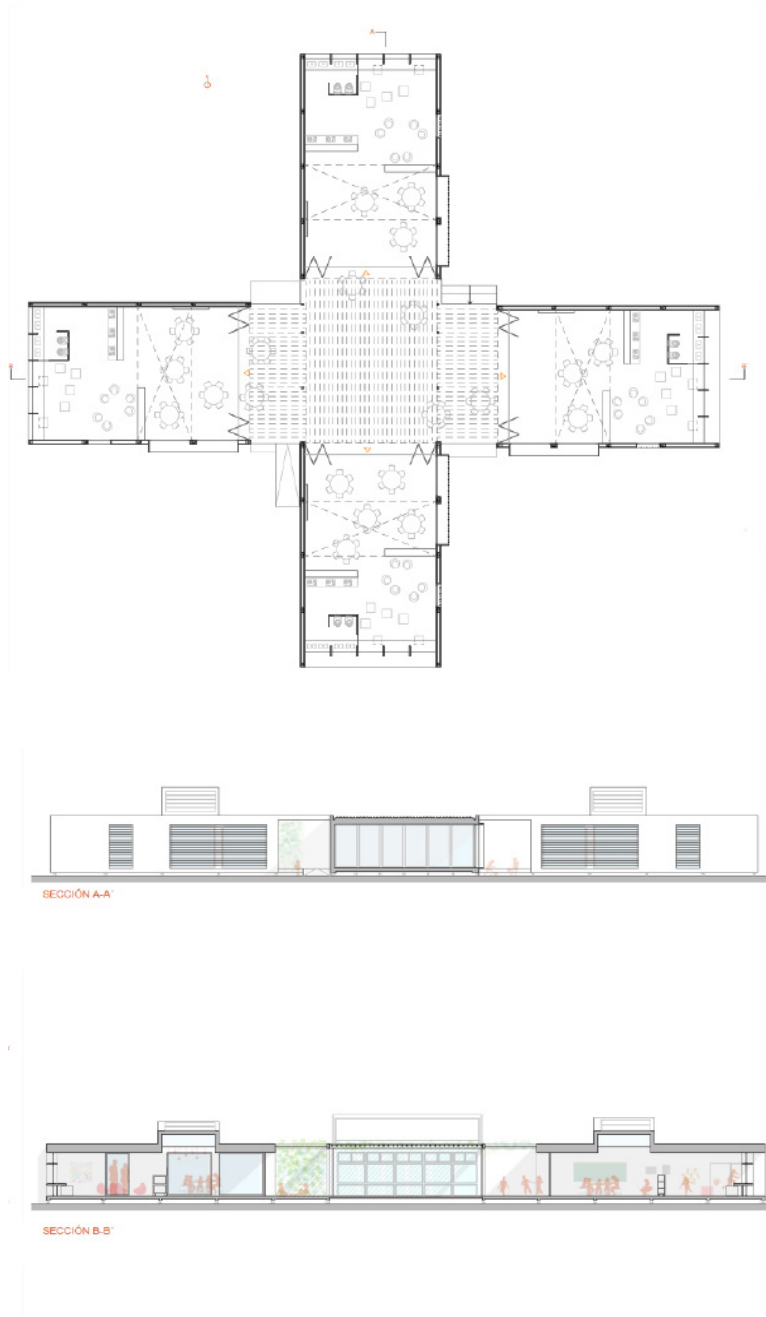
Planimetría de la propuesta de agrupación 3.
